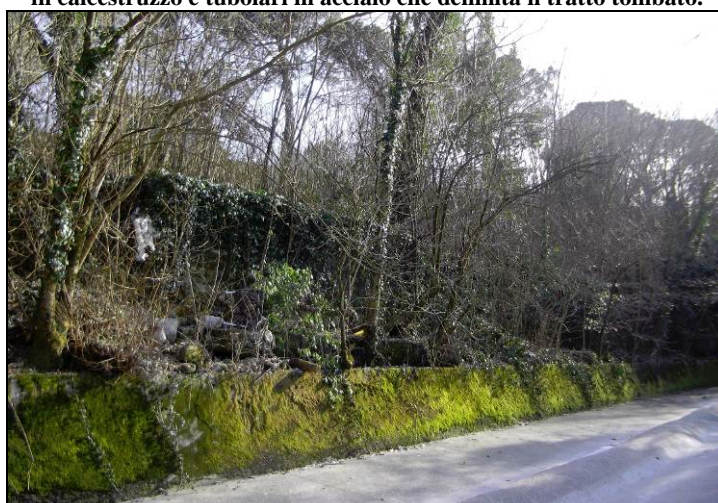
particolare del muretto che delimita il torrente Corno coperto. La pietra è locale, tipo carsica o arenacea marnosa. Il progetto non prevede alcun cambiamento dello stato attuale.
